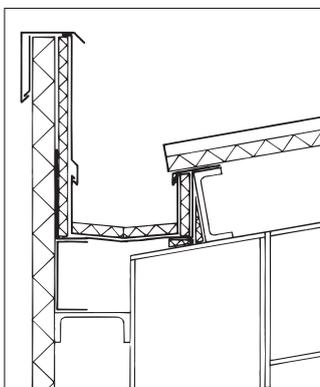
a: Traufpunkt mit Attika, Satteldach, PUR-Sandwichelemente
